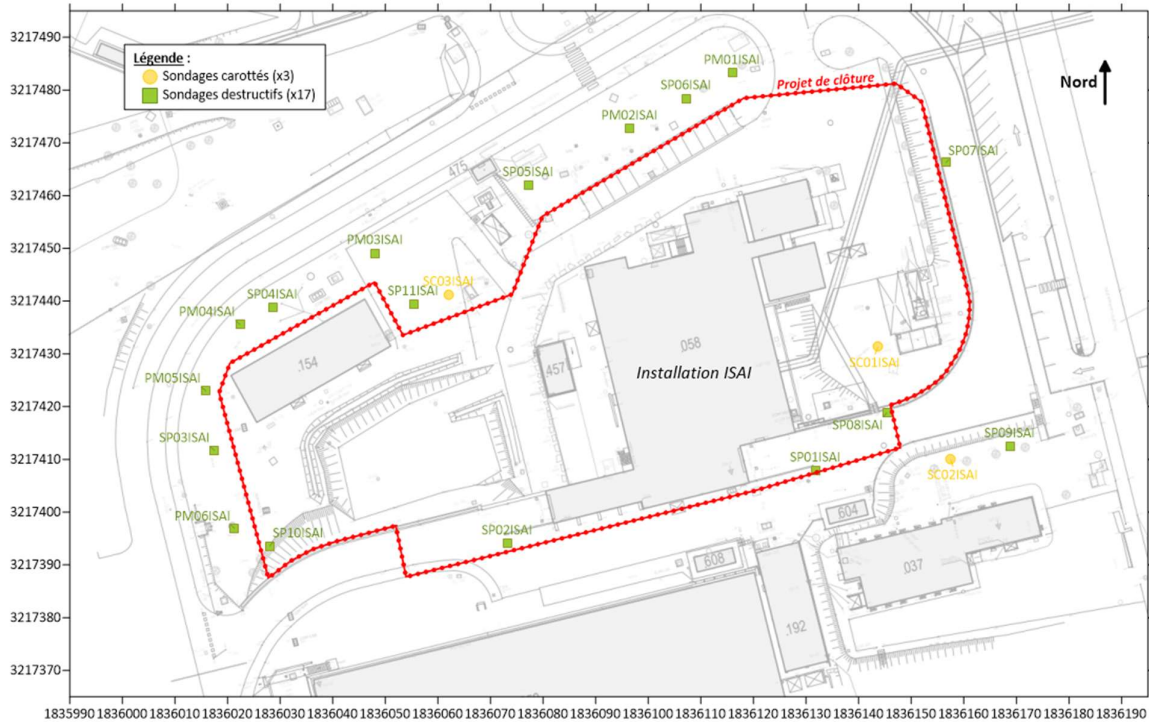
Plan d'implantation des sondages d'ABO ERG par type de forage
